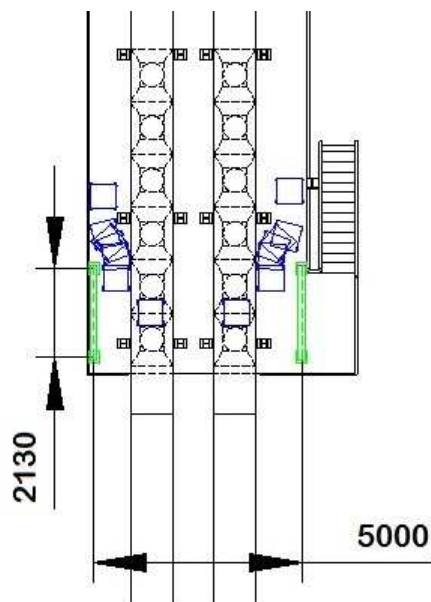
Comprimento das vigas intermediárias da estrutura.
